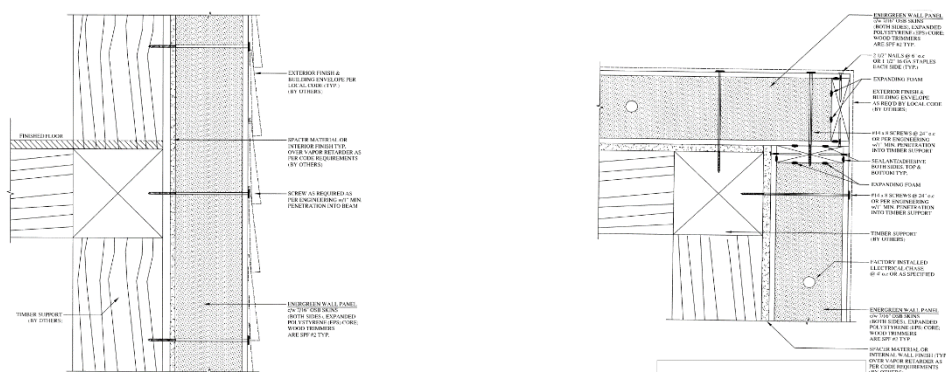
Detalhes - Corte (pavimento parede exterior) e planta (canto de paredes exteriores) (San Juan Timber Frames, 2015).
